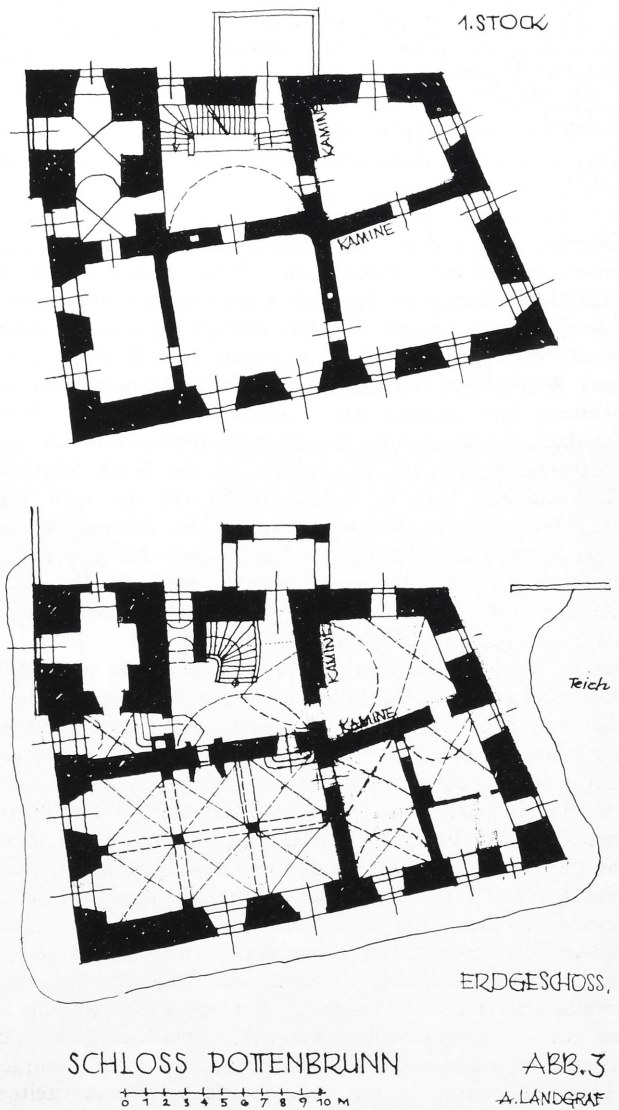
Wasserburg Pottenbrunn, Grundrisse (Maßaufnahme des Verf.)
